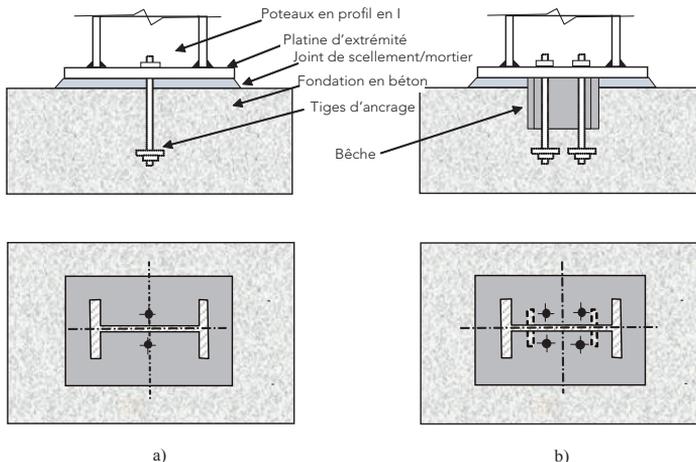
Assemblages de pieds de poteaux dits « articulés ».
